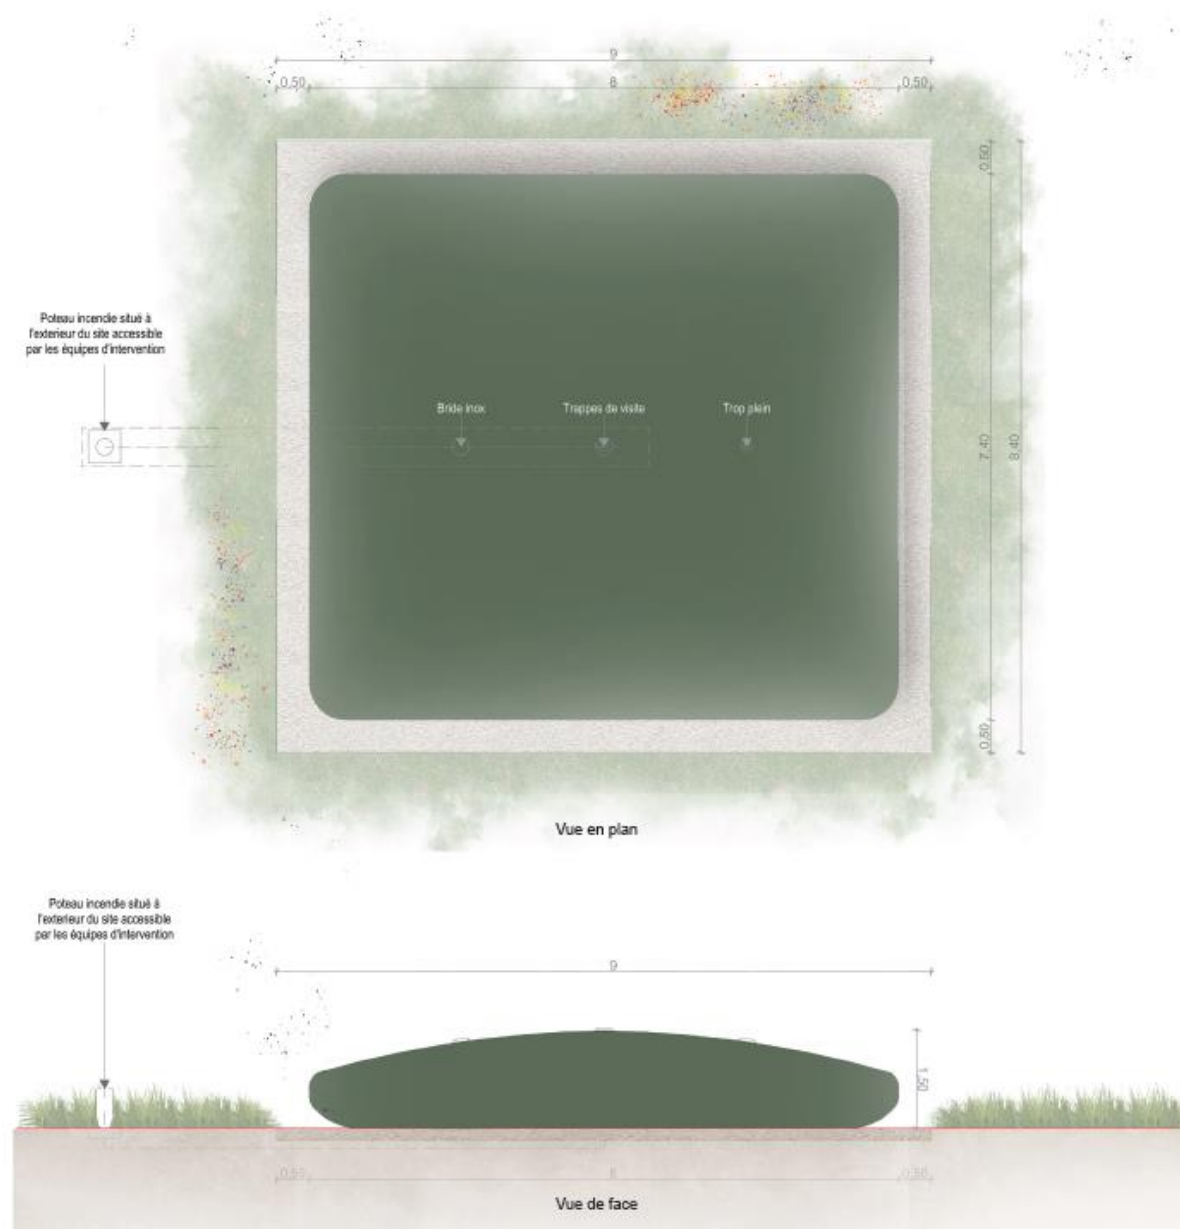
Vue des façades d'une citerne. Source : PHOTOSOL
